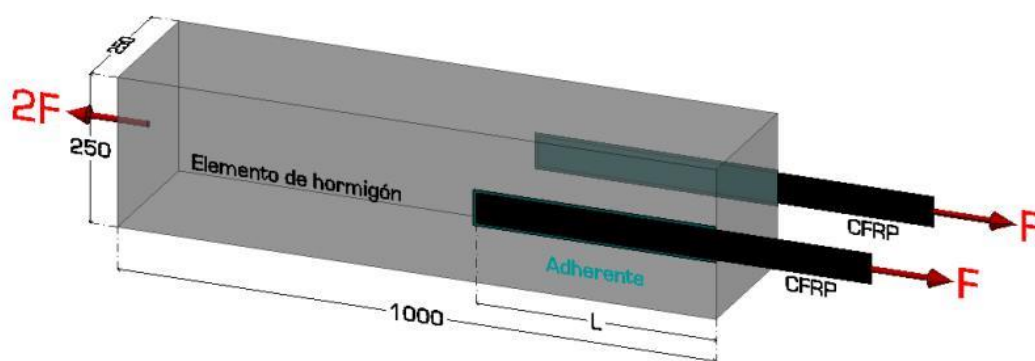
Configuración ensayo doble cortante, dimensiones en mm.
